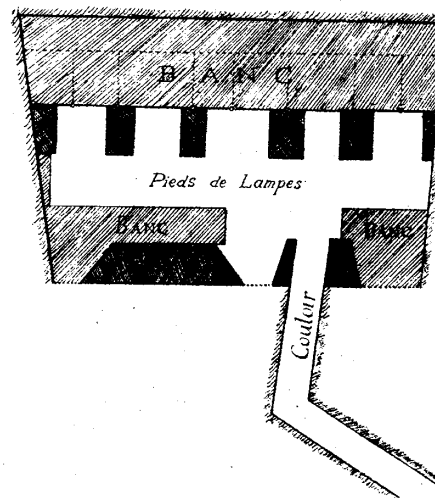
Plan de la maison d'Angmagssalik (H. B.).
